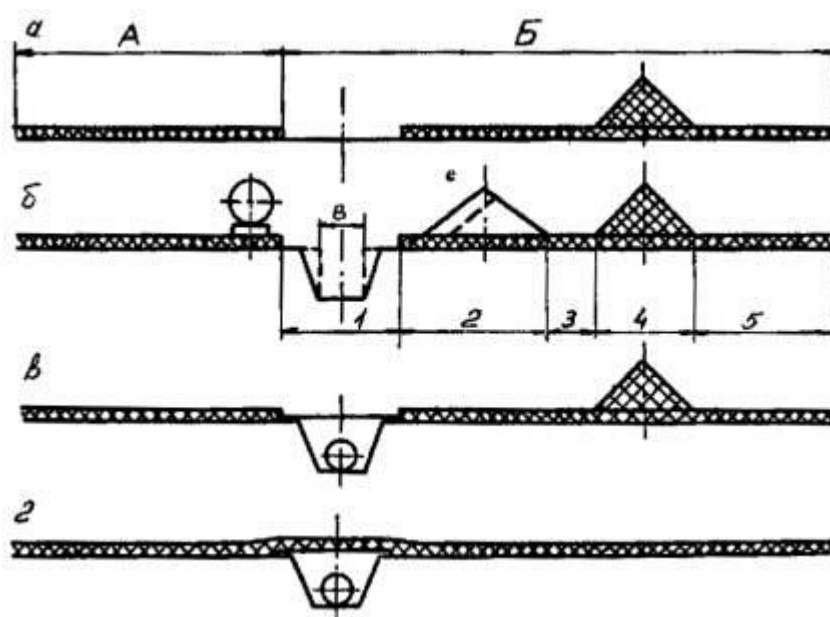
Схема планировки последовательных операций земляных работ при строительстве трубопроводов:
